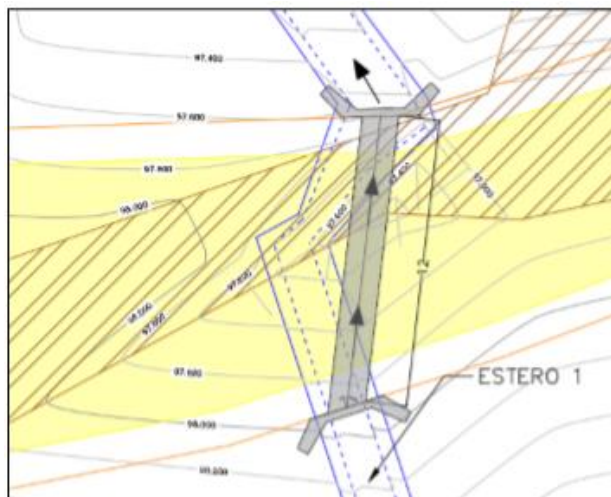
Imagen en planta de Atravieso Estero 1
